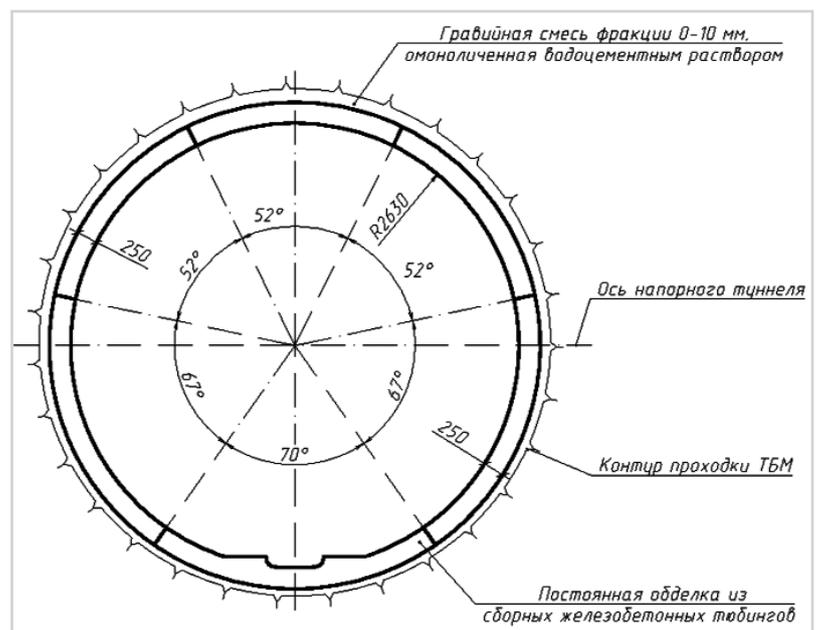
Типовое поперечное сечение напорного туннеля из сборных железобетонных тубингов
